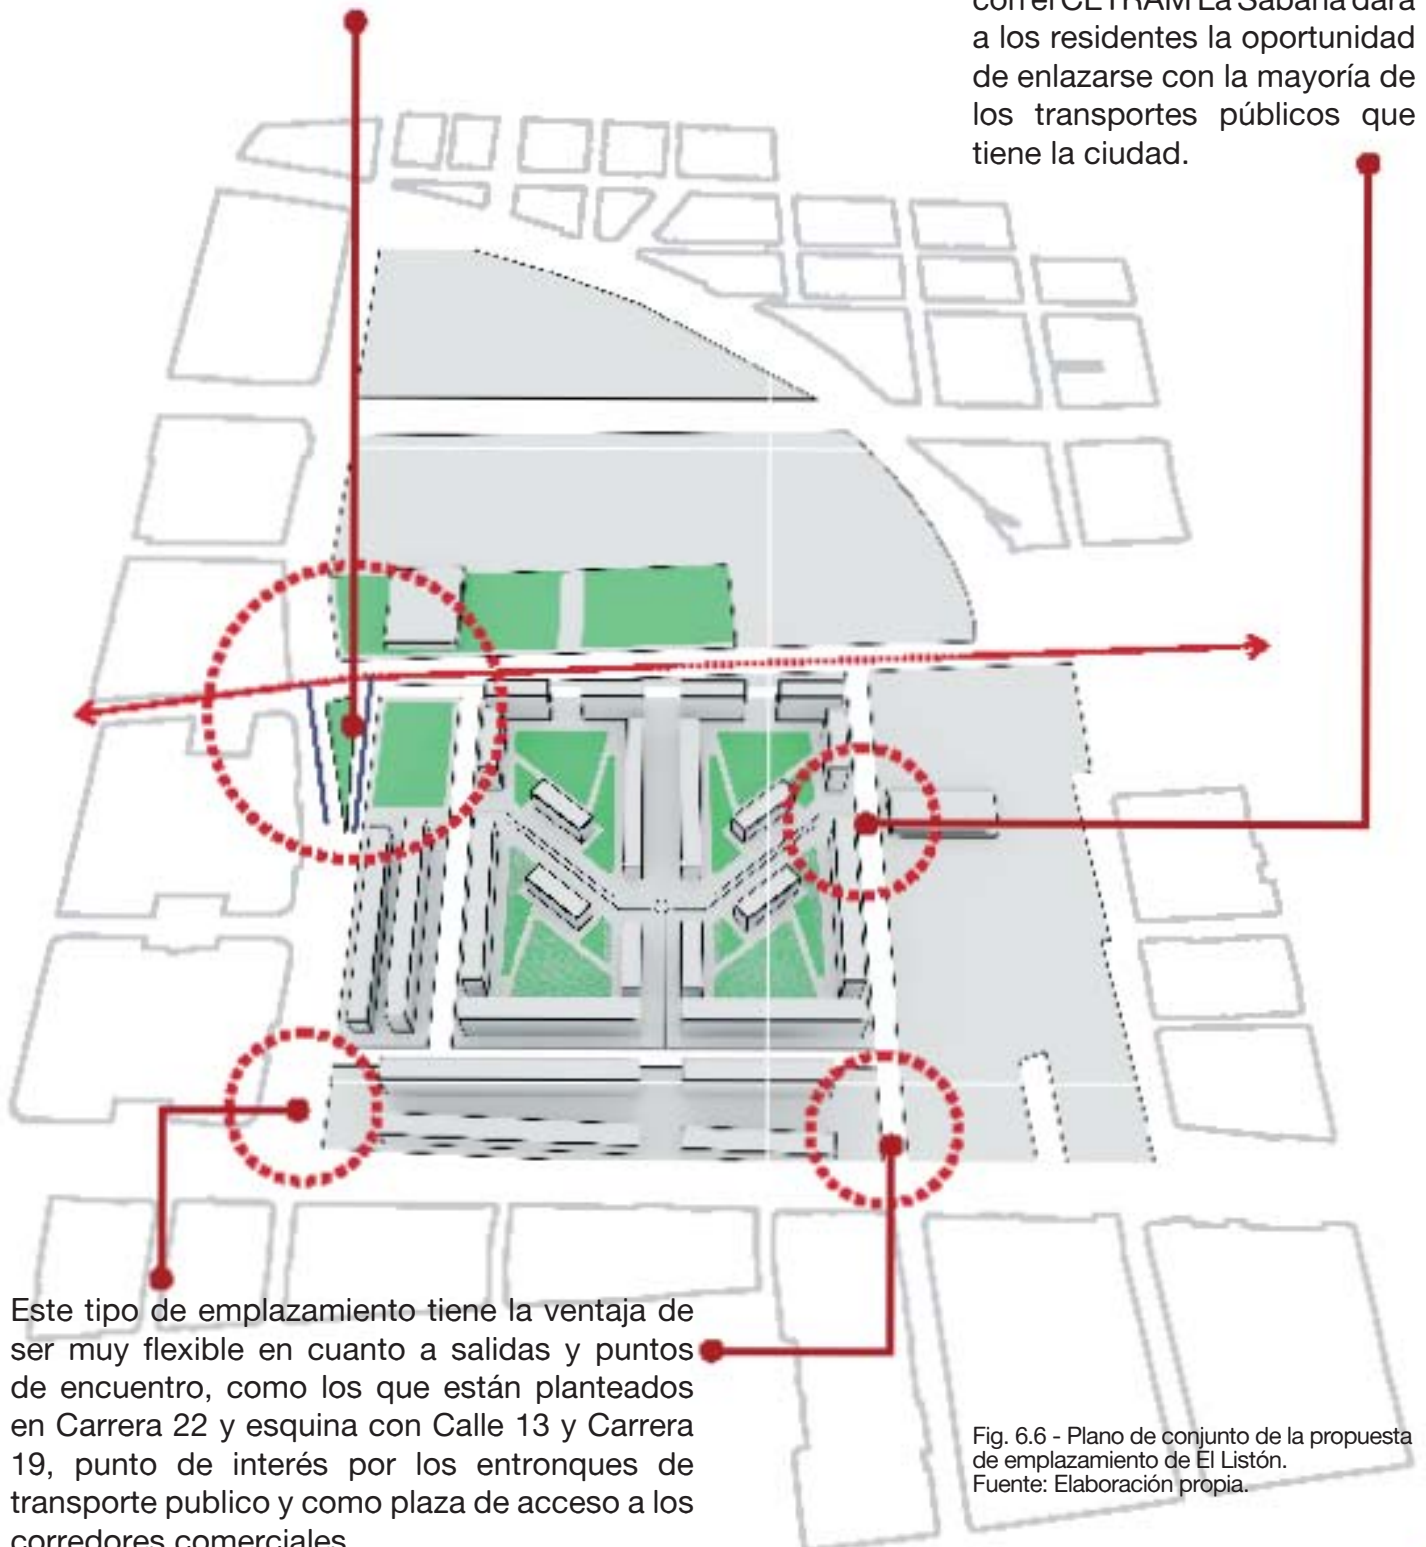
Plano de conjunto de la propuesta de emplazamiento de El Listón.
